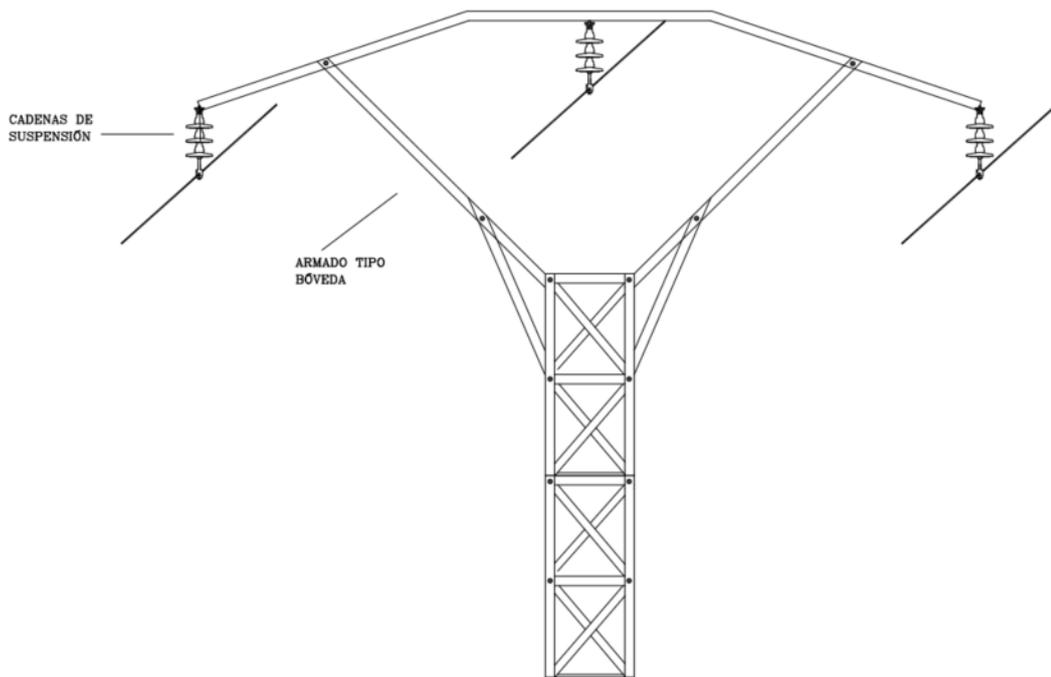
Apoyo tipo bóveda con cadenas de suspensión
